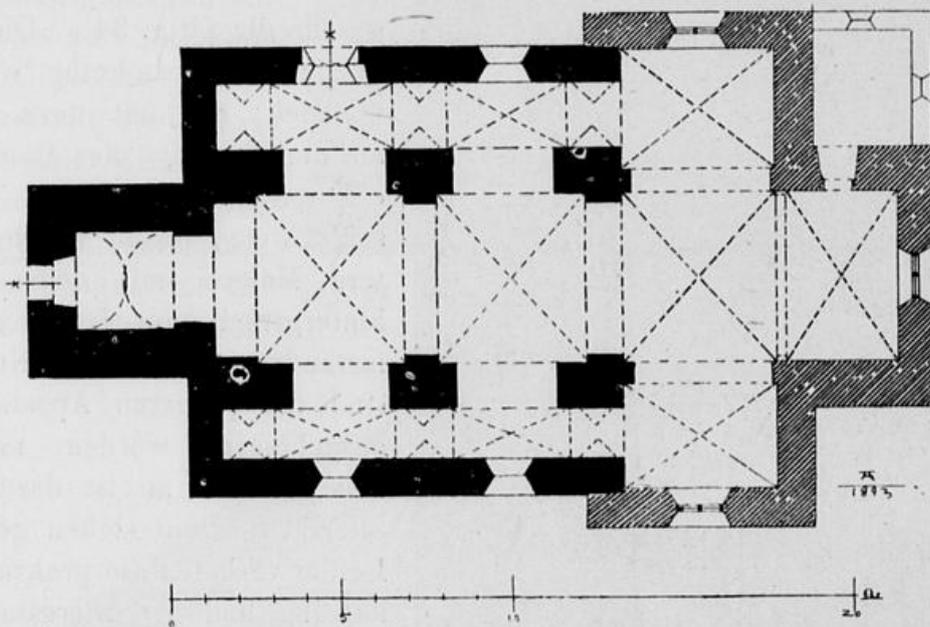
Müllenbach. Grundriss der evang. Pfarrkirche.
